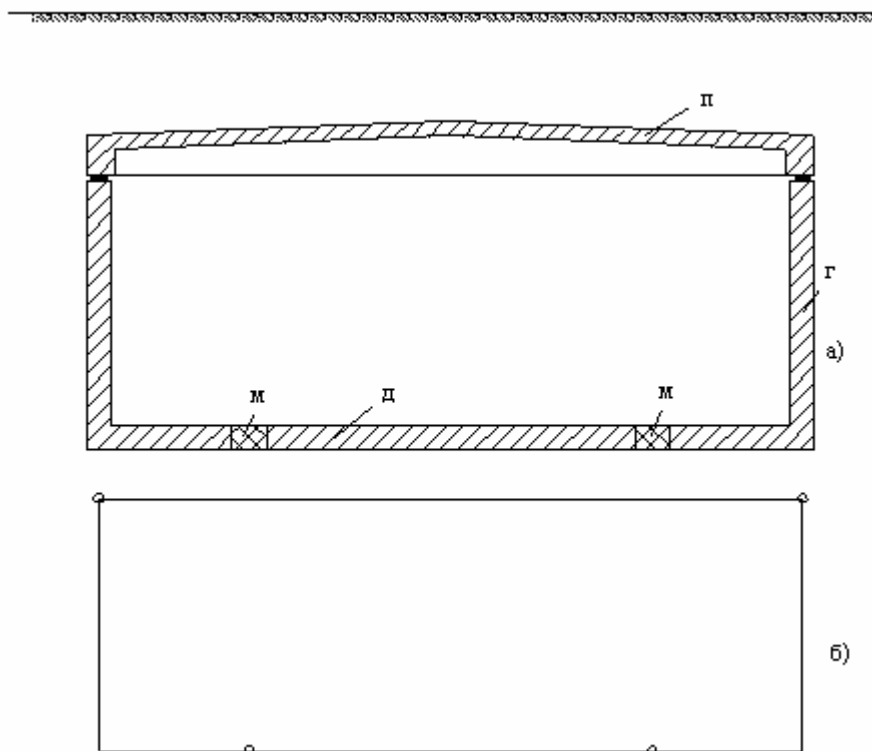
Сглобяема конструкция от фундаменти и П-образни рамки
